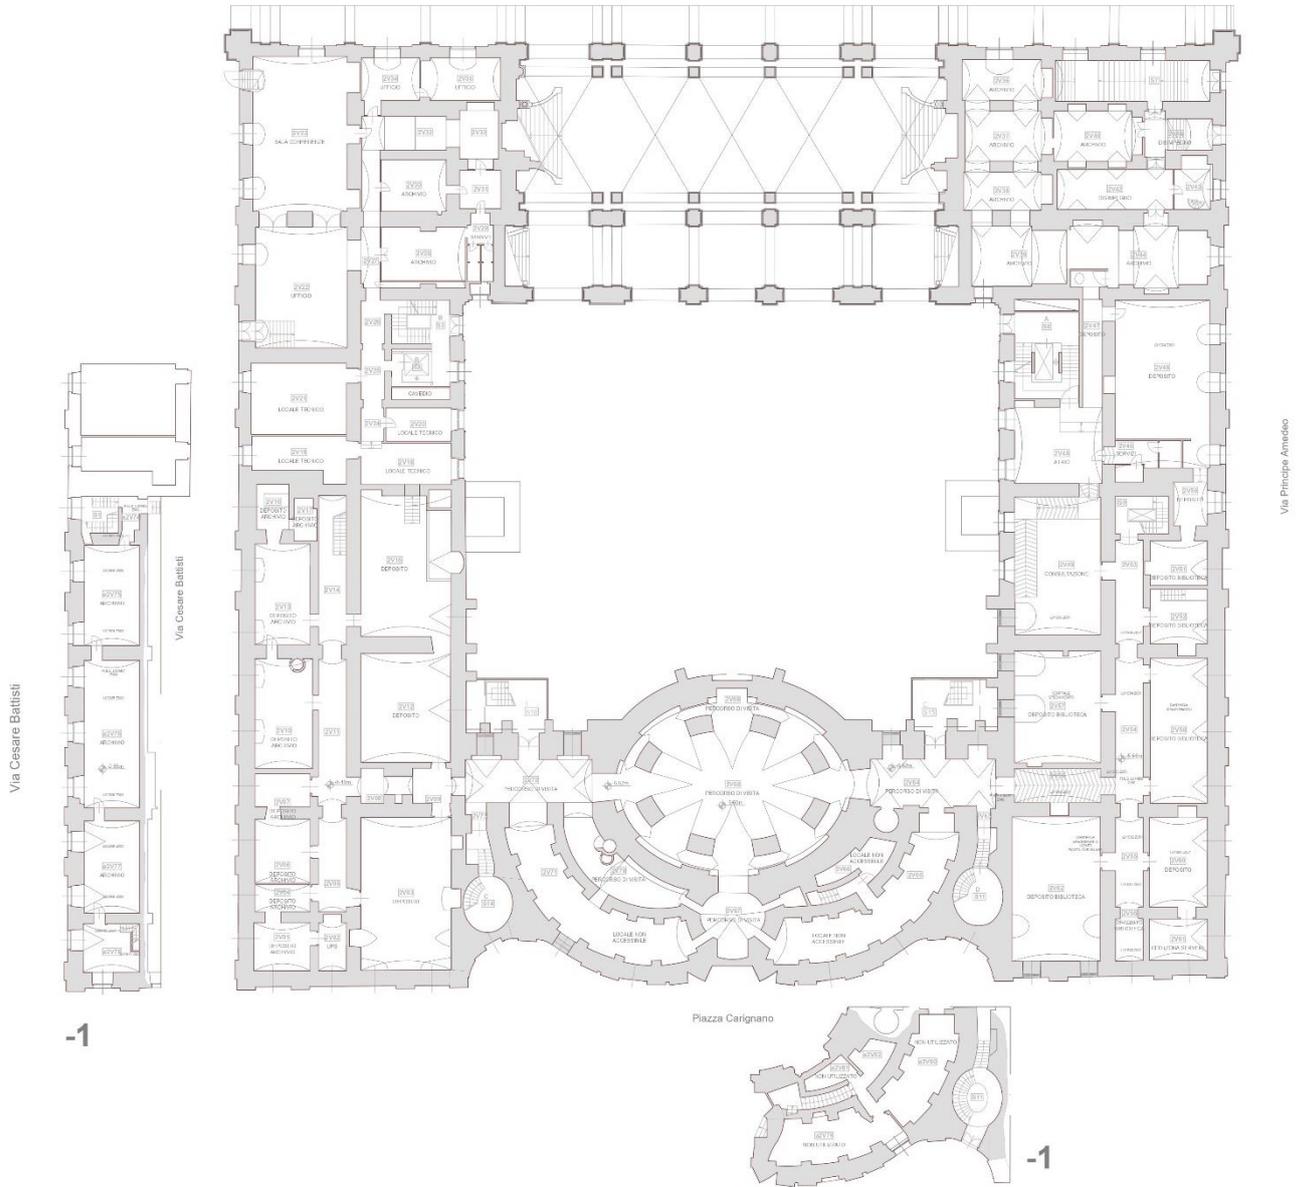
Pianta piano seminterrato-ammezzato, livello -2 e -1 (Fuori scala).
